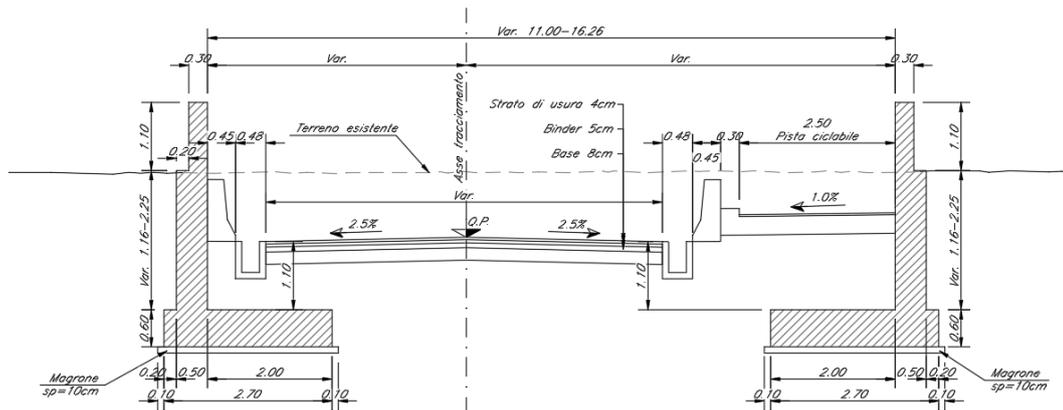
Sezione trasversale conco 1 ovest, in corrispondenza dell'inizio della rampa
